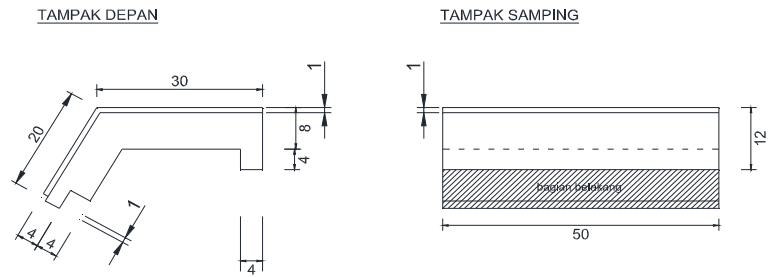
Modul Dinding atau Lantai Tipe-S Beton Pracetak Modular
